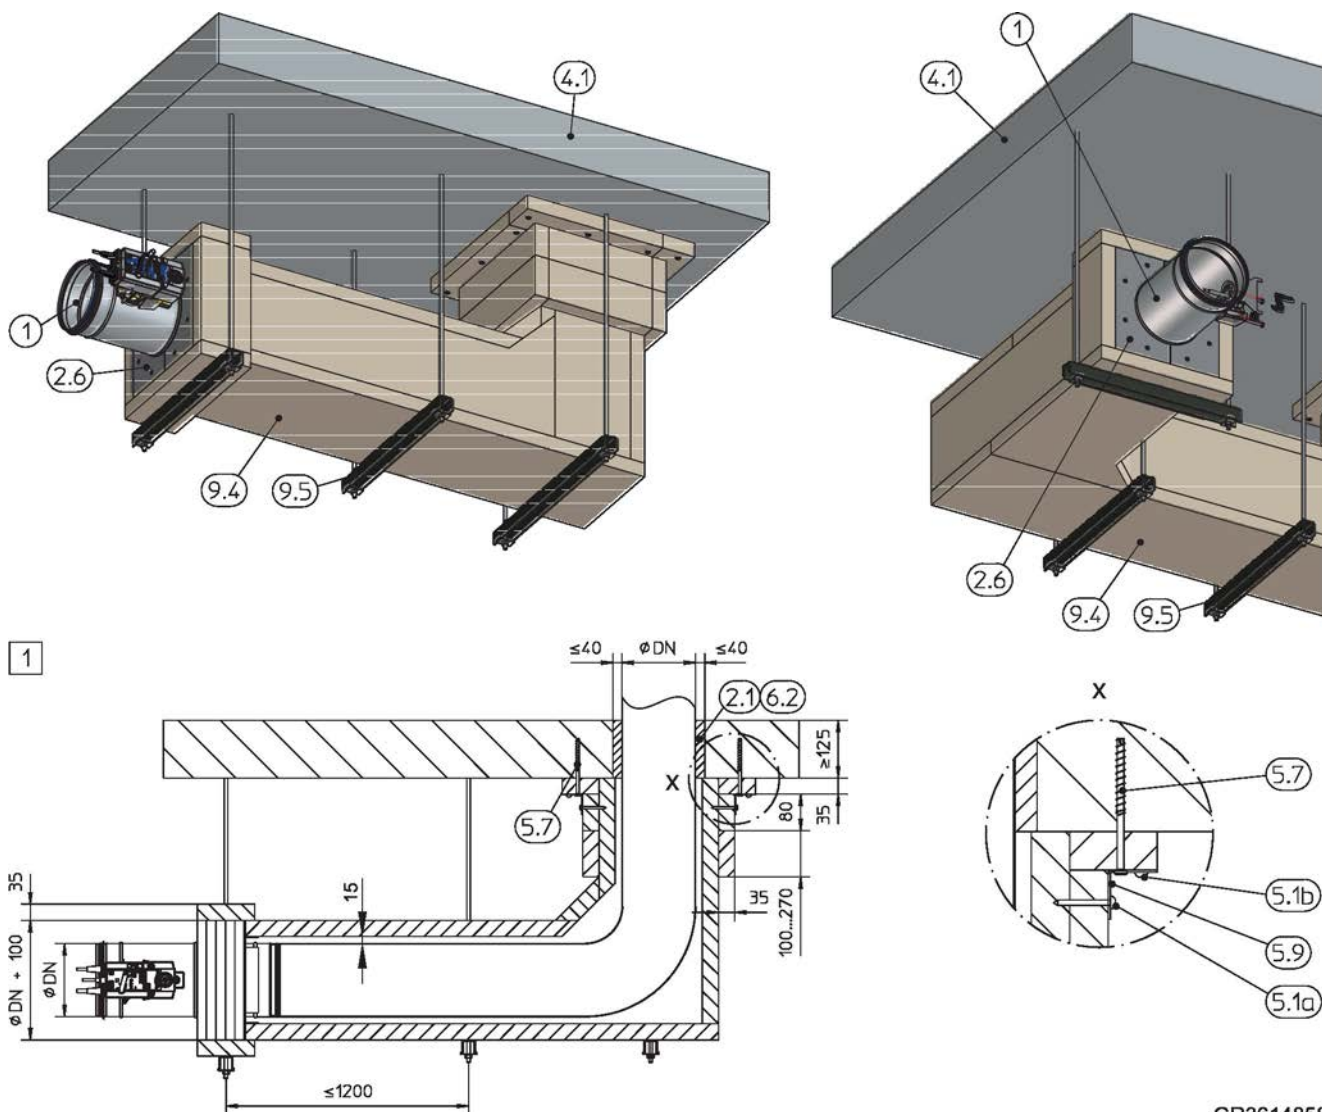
Монтаж без применения строительного раствора с монтажным блоком ER в сплошных перекрытиях, вертикально или с подвесом
